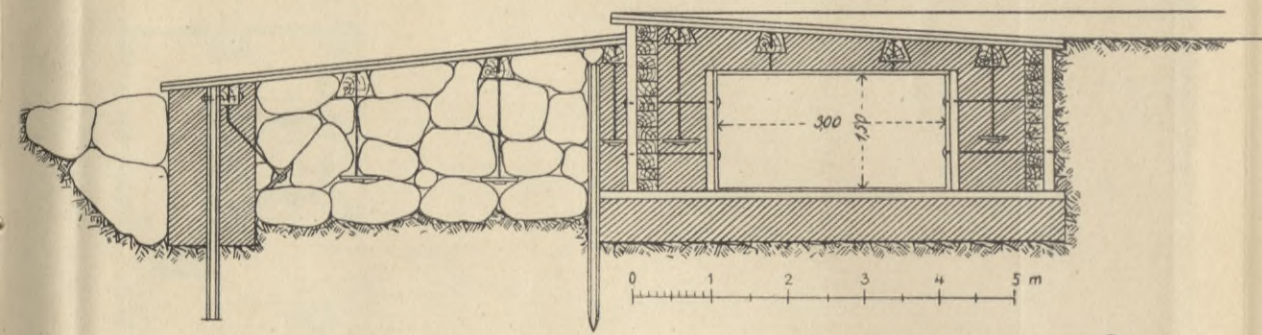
Schnitt C-D durch den Einlauf nach Figur 2.
